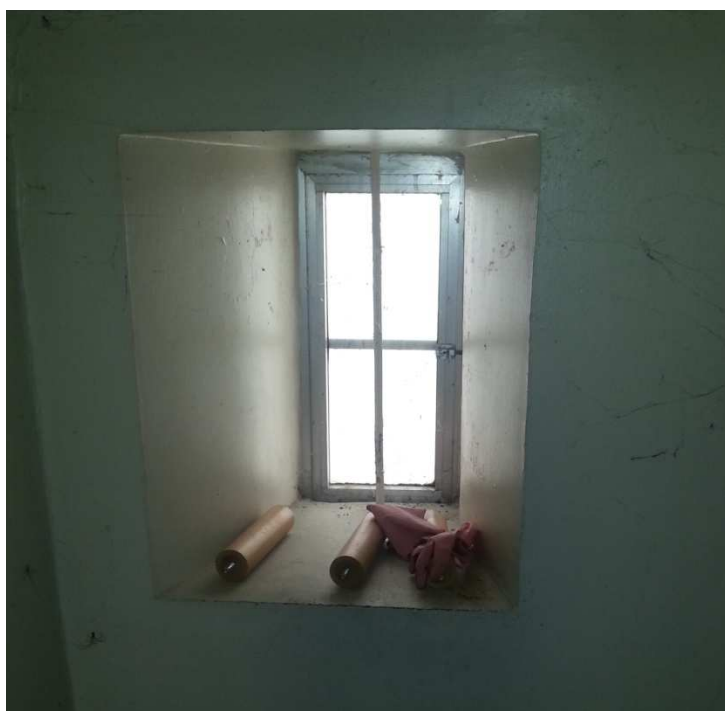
Ventana abocinada, formada por carpintería metálica fachada Sur (Fuente: elaboración propia)
